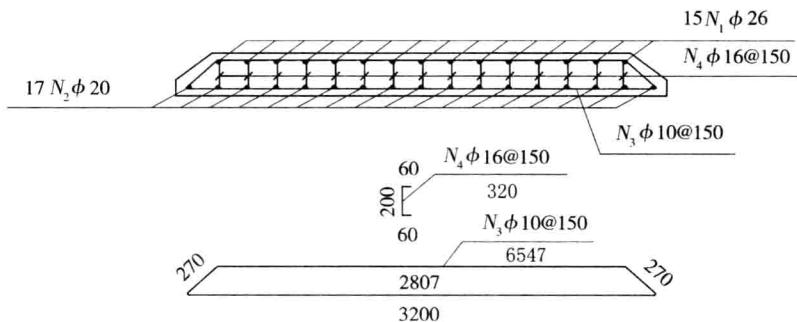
现浇钢筋混凝土支撑层钢筋构造图
